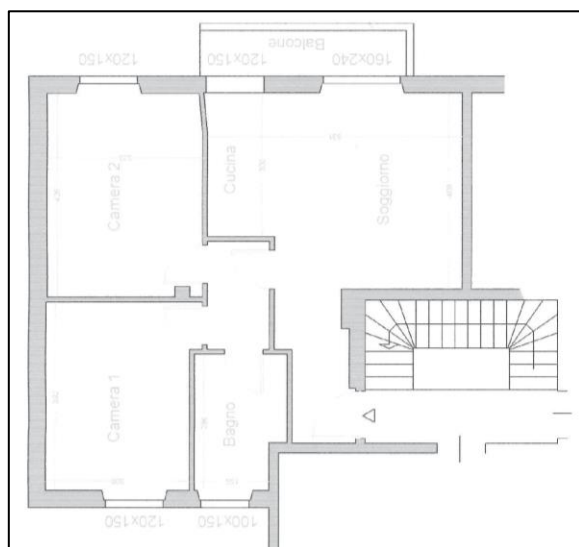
Planimetria allegata alla CILA del 29.5.2017
